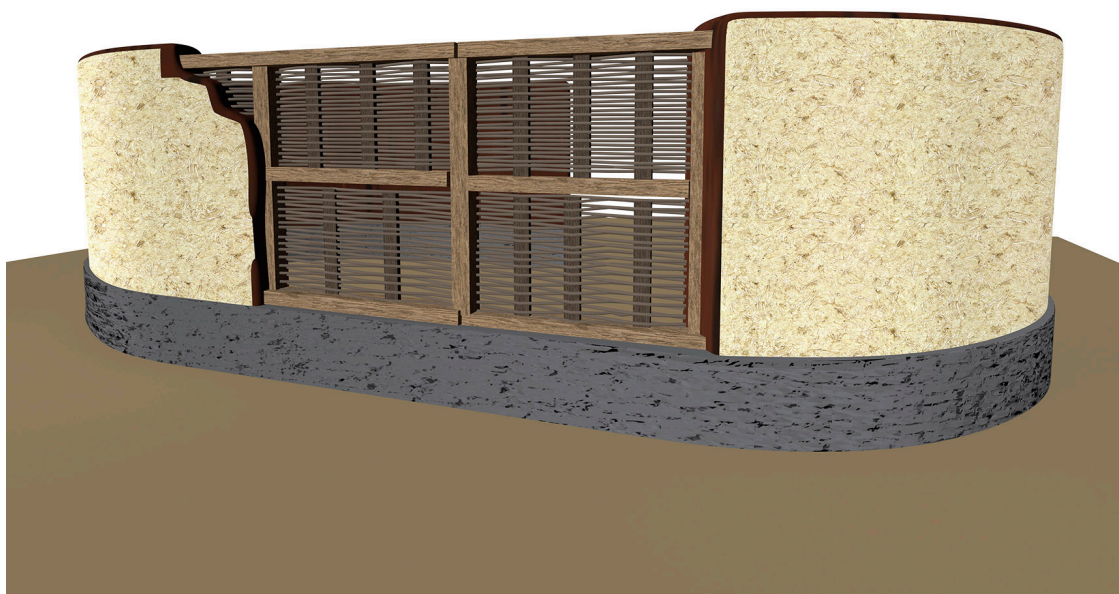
Reconstrucción de alzados de tierra: a. Zócalo de piedra y encestado; b. Zócalo de piedra, entramado y relleno de encestado. © Lucía Ruano
